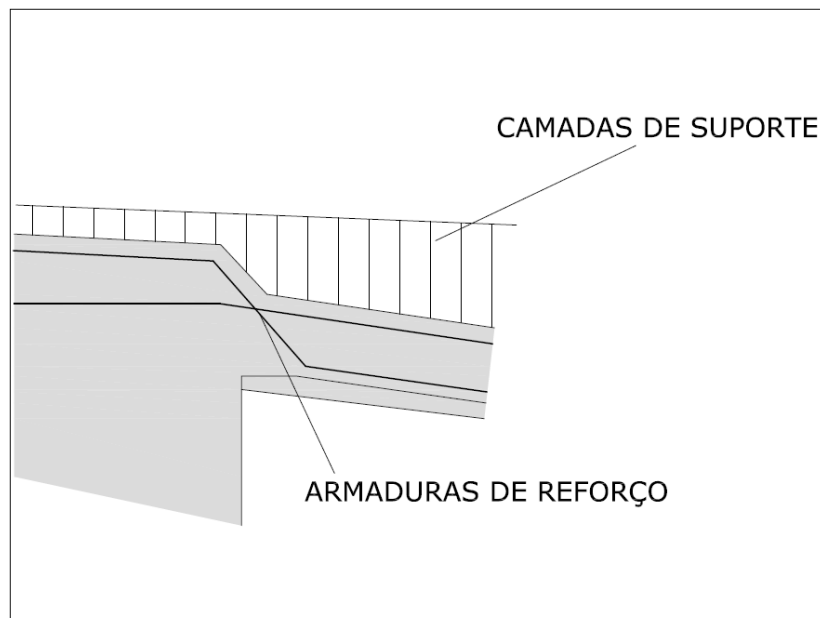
Reforços na região da laje de transição para evitar fissuras no pavimento, adaptado de DREIER et al (2011).
